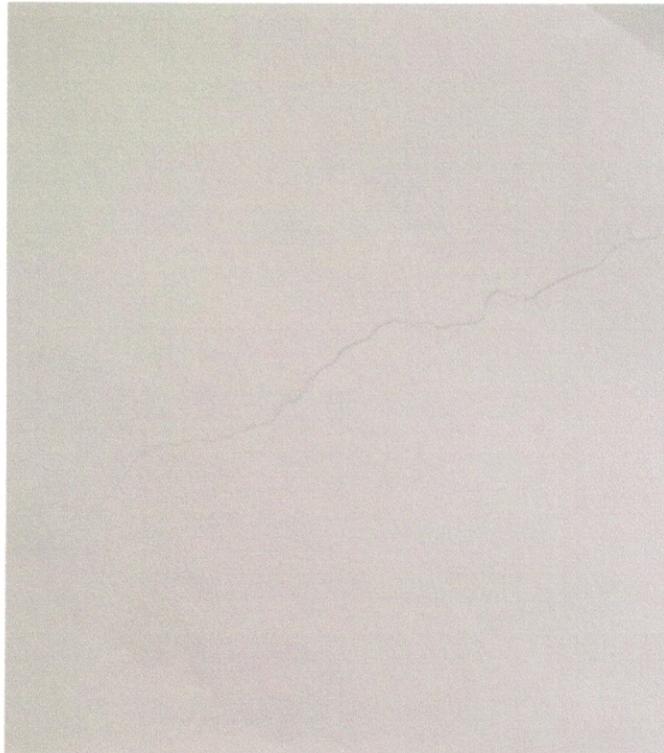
Fissura na parede da sala de enfermagem
